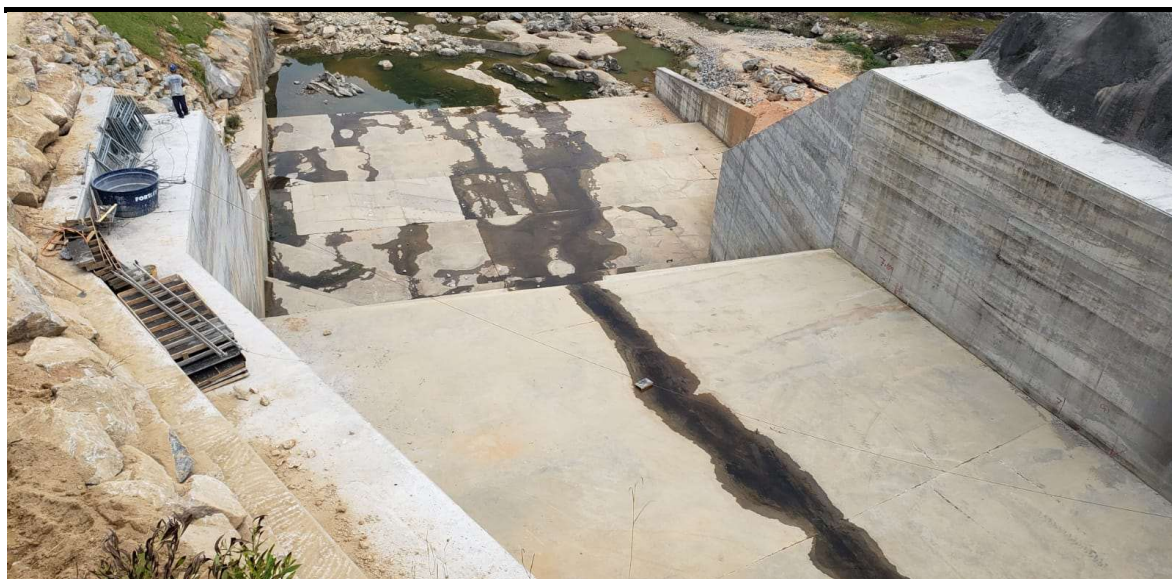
Vista de Montante da Escada de Dissipação do Canal Lateral
